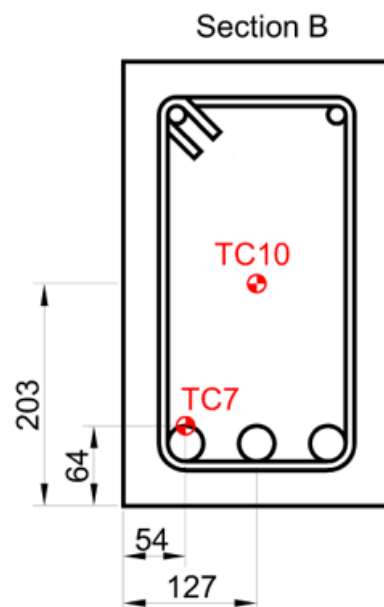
Emplacement des thermocouples pour la mi-travée de la poutre (section B) (Dim. en mm) [64]
